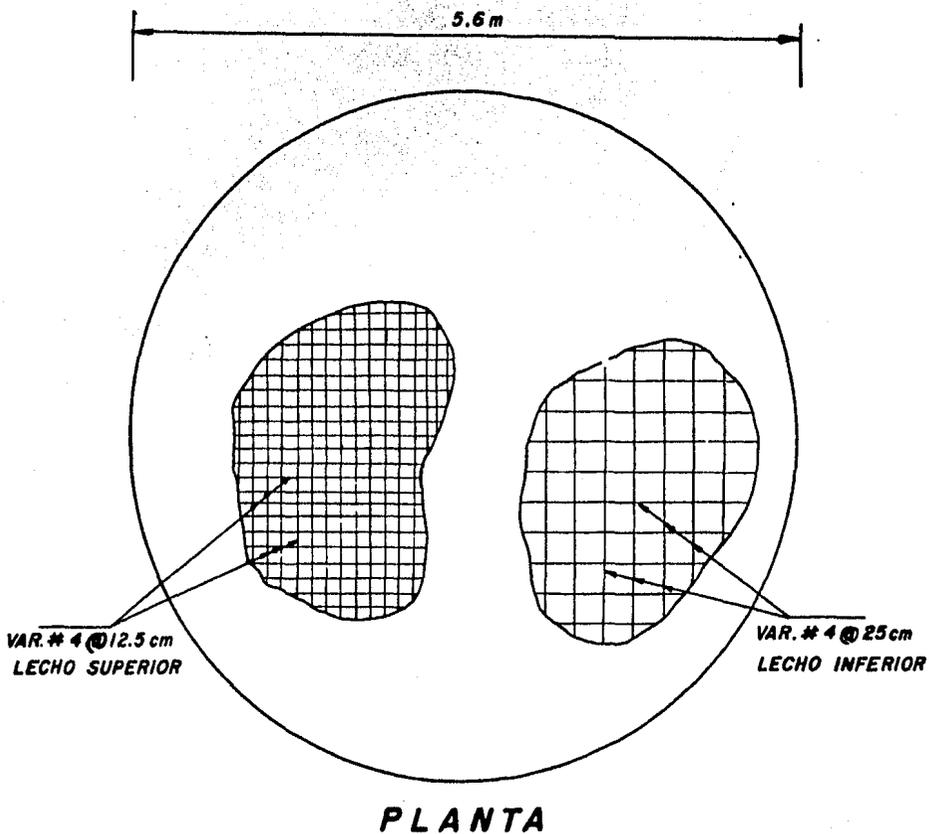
DETALLE DE ARMADO DE LA LOSA DE FONDO
